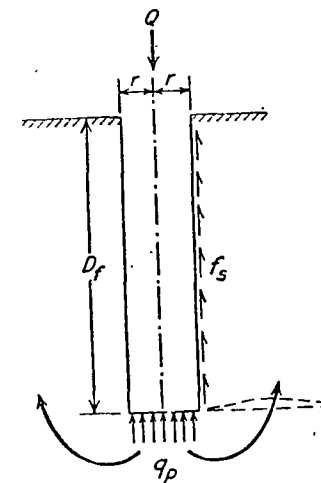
Sección vertical por el centro de pilar de fundación cilíndrico.
